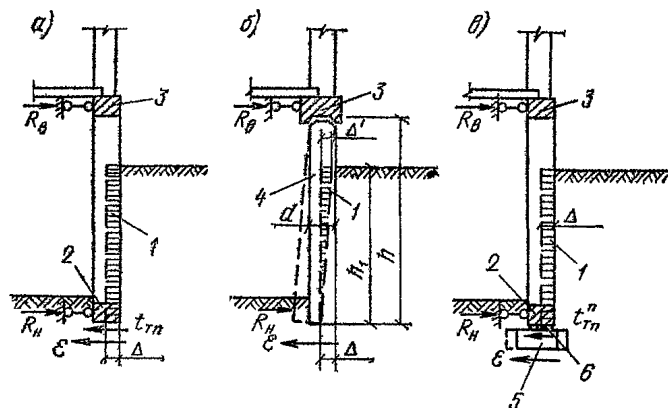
Эпюры обжатия грунта при воздействии деформаций сжатия на фундаменты
